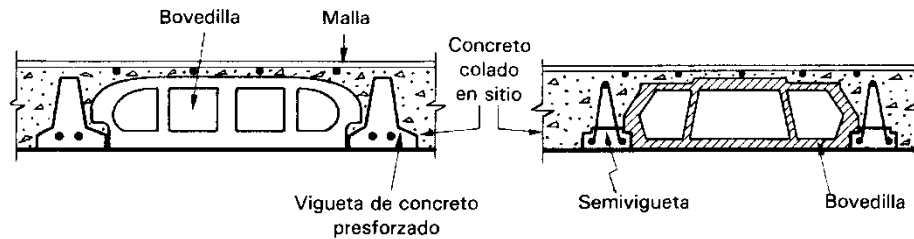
Sistema de piso de vigüeta y bovedilla.
